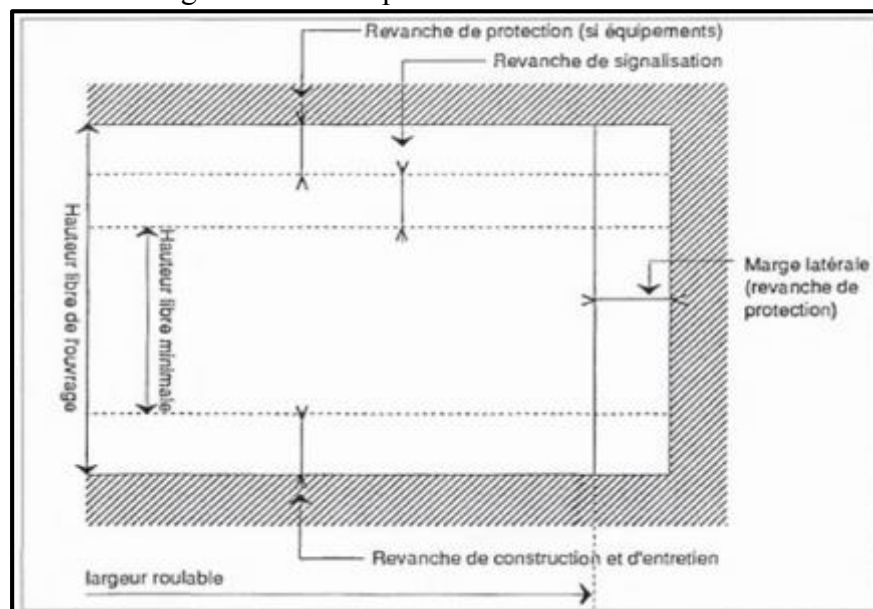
Dimensionnement de la hauteur des ouvrages
